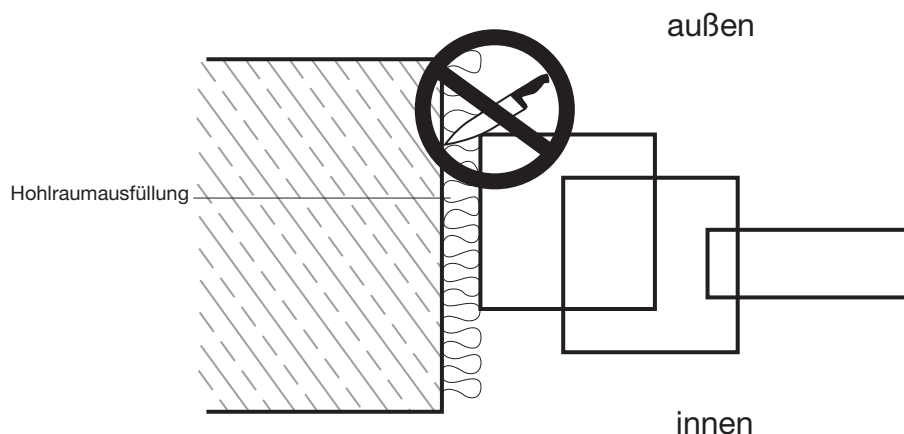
Nicht fachgerecht ausgeschäumte Fugen.
